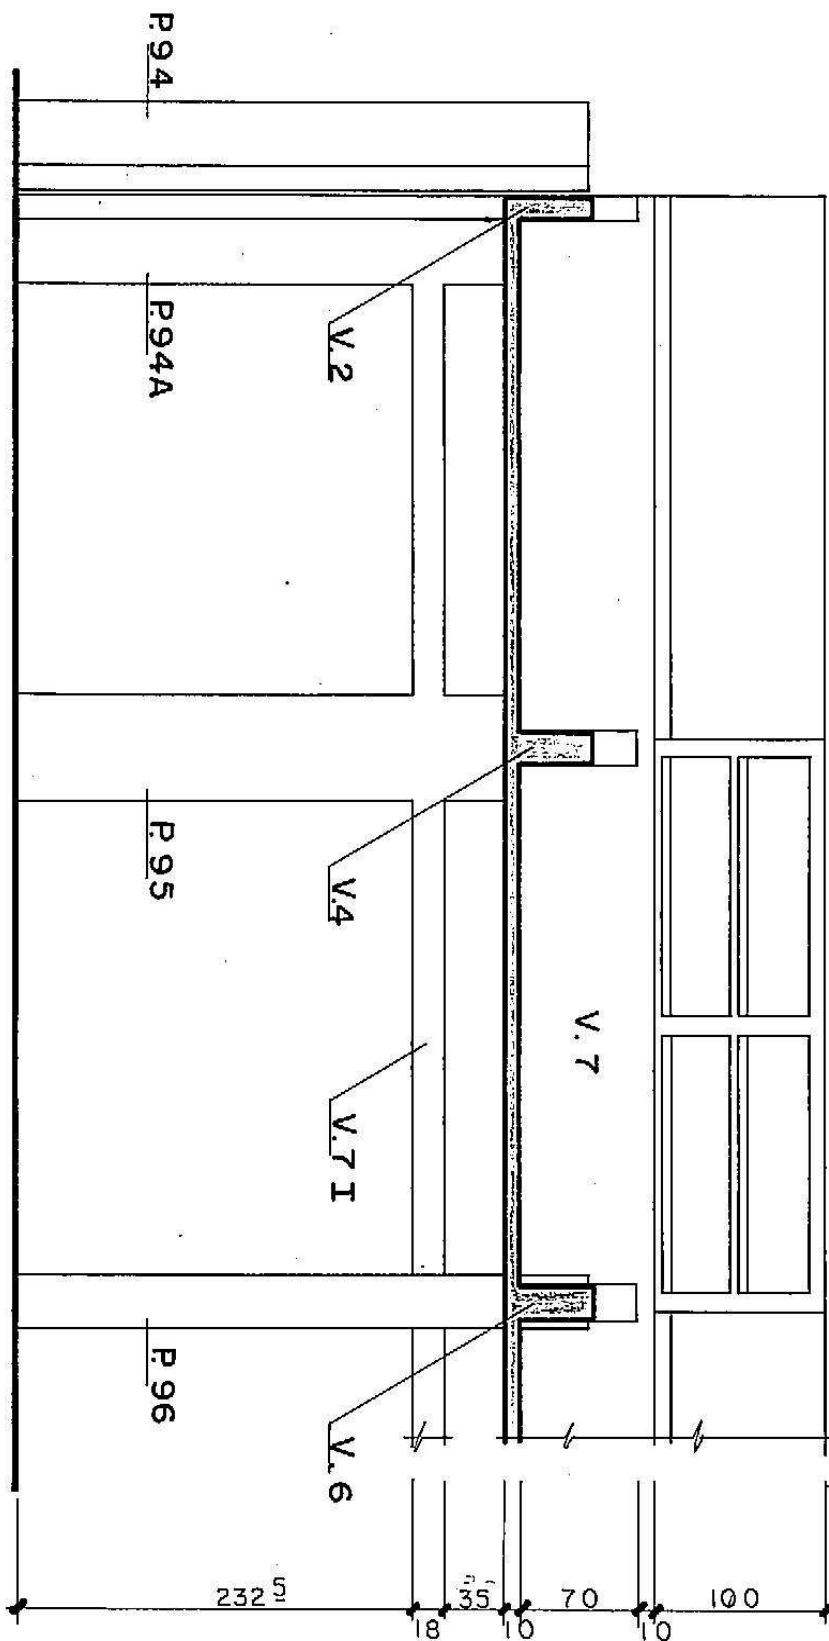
Visualização do corte C-C, do elemento *shed* (CEPLAN - UnB, 2008)
